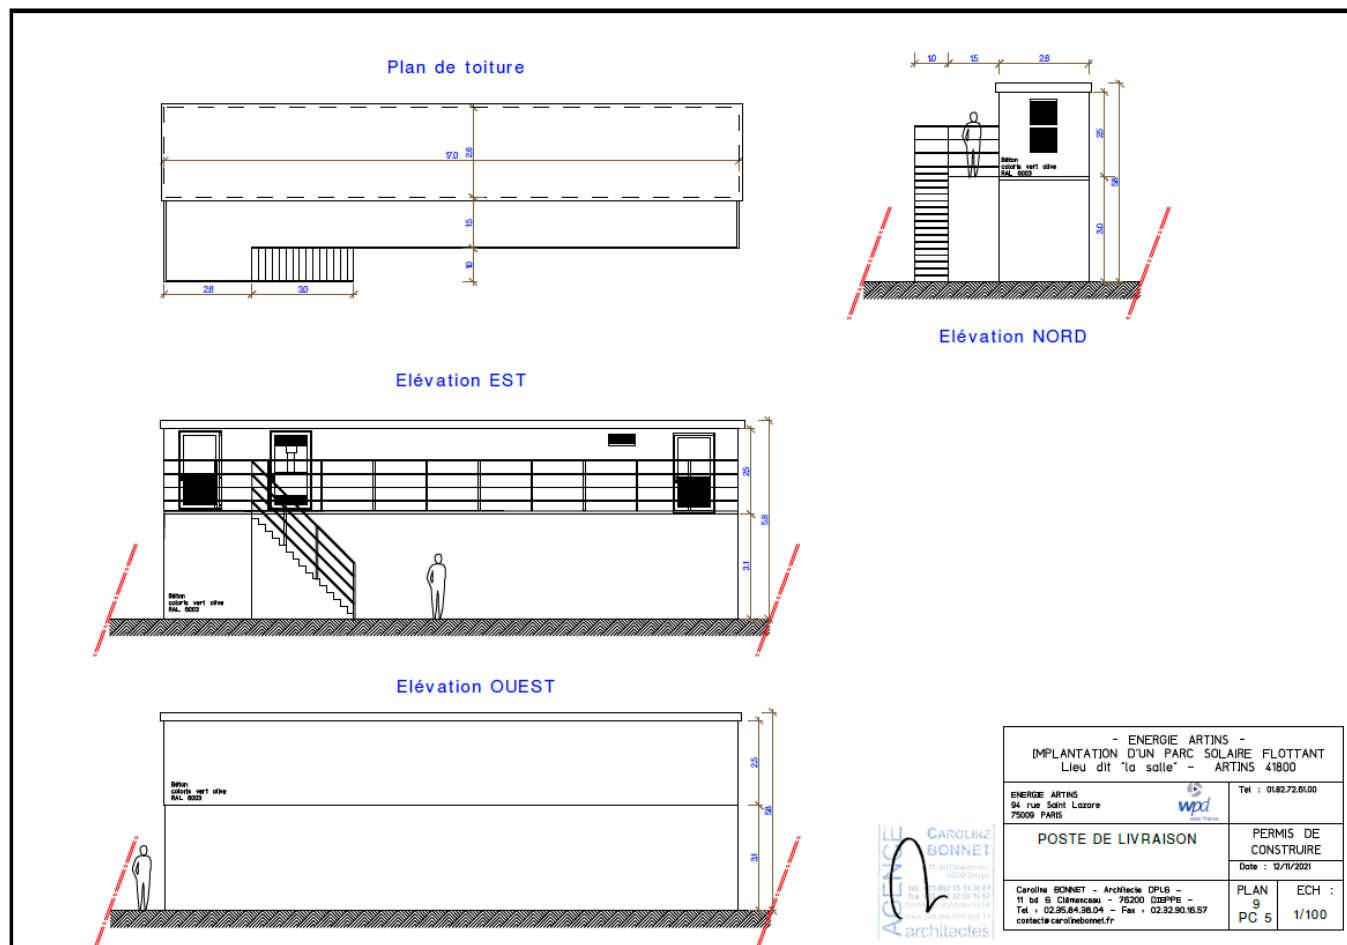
Plan de coupe et façades d'un bâtiment technique regroupant un poste de transformation et un poste de livraison
